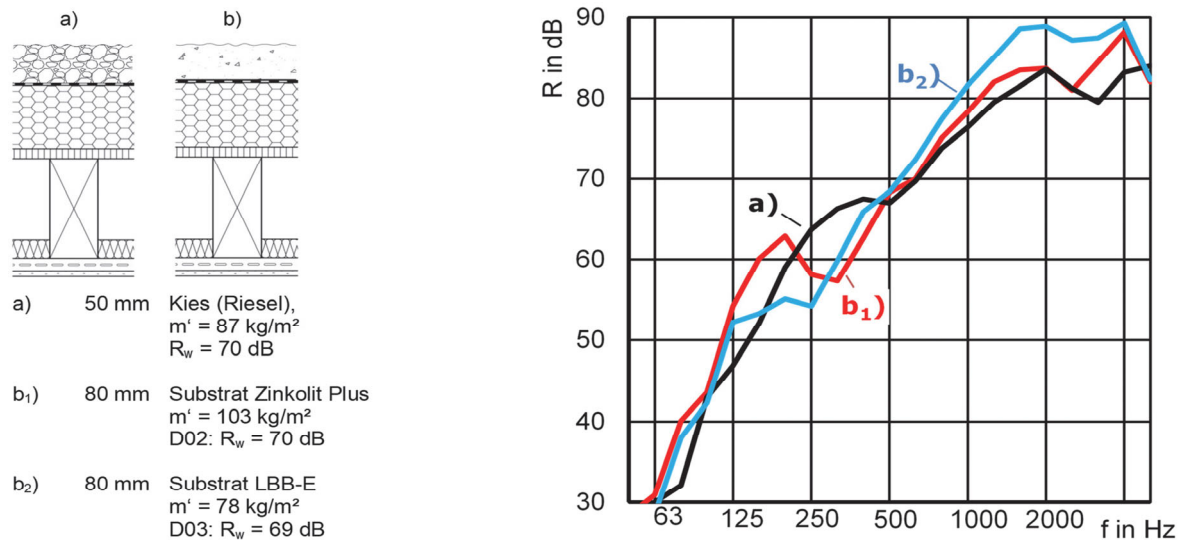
Vergleich zwischen Kies (Riesel) und Gründach-Substrat auf: Dachbahn, 140 mm Hartschaum-Dämmplatten, Holzwerkstoffplatte, 220 mm Balkenlage mit 40 mm Faserdämmstoff, Federschiene, 12,5 mm GKF. Referenzaufbau ohne Drainageebene
